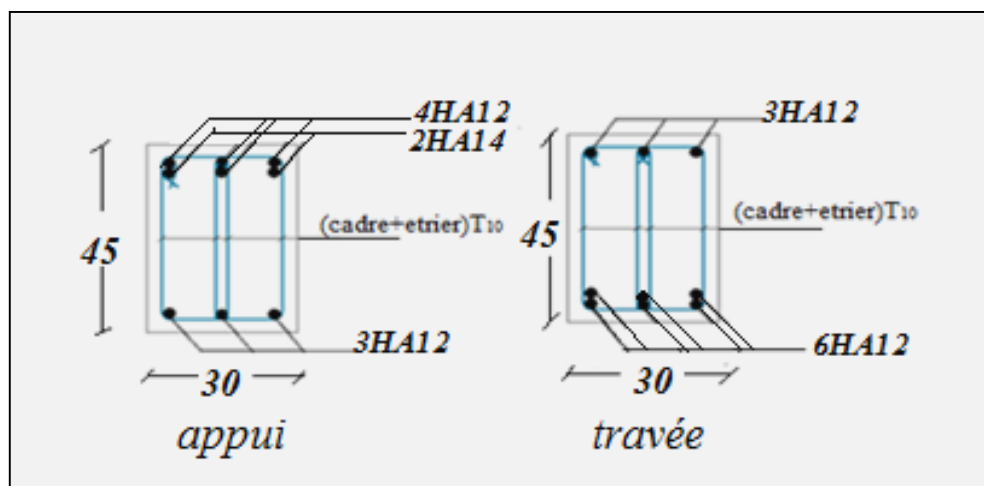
Schéma de ferrailage des poutres secondaires (étage).
